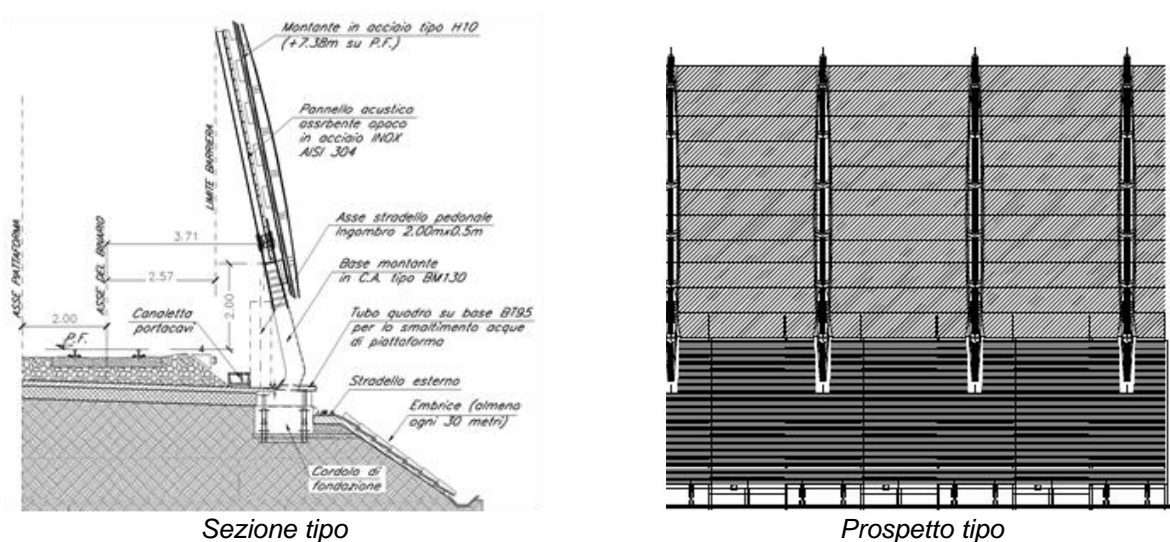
Sezione e prospetto tipo del modulo di barriera antirumore previsto
